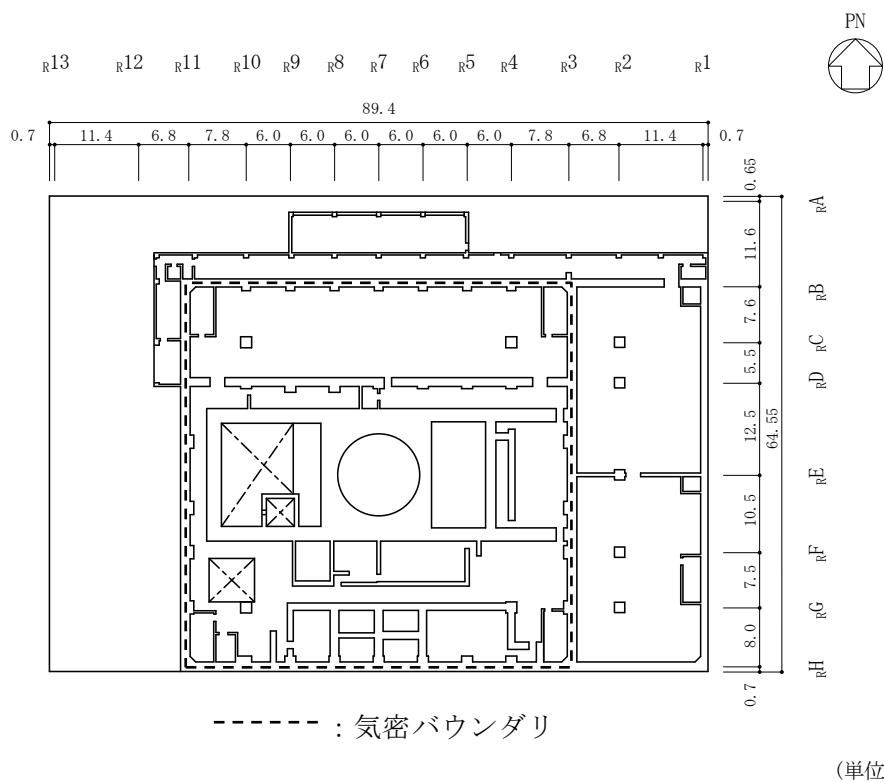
(6) 原子炉建物原子炉棟（二次格納施設）の概略平面図（EL 34.8m）
